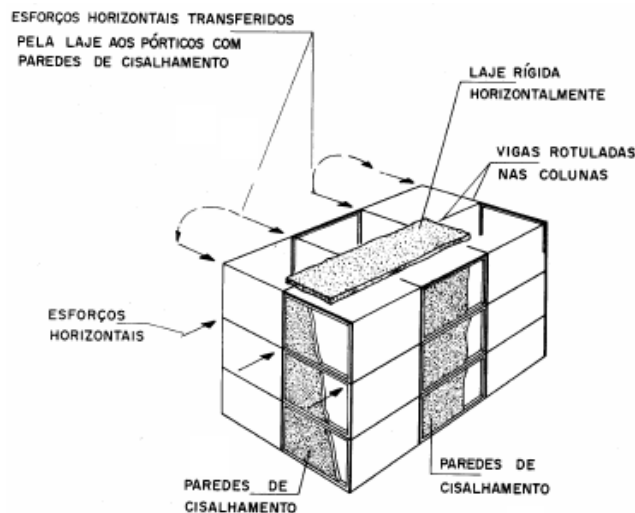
Parede de contraventamento ou cisalhamento em um vão
